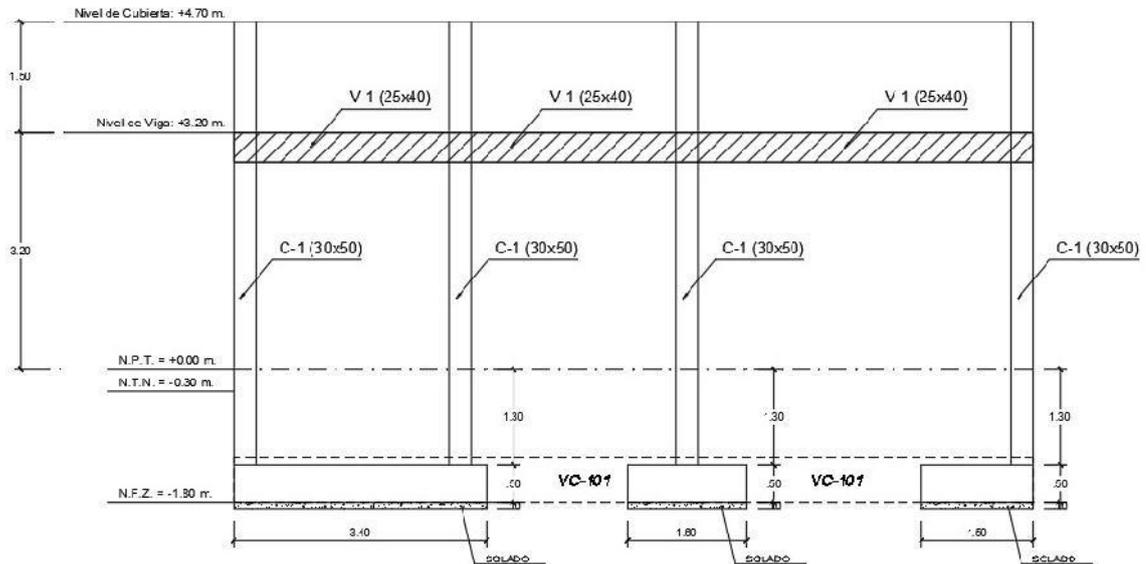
Detalle de zapatas en la vista en planta de cimentación del plano E-14
